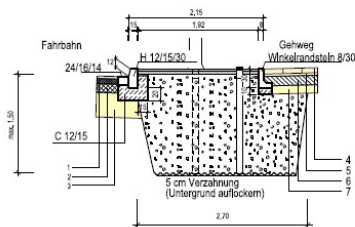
Musterzeichnung Baumbeet, Stadt Aachen
